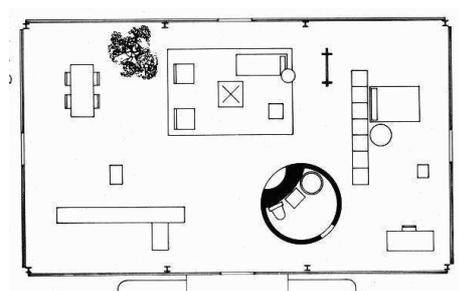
Casa de Vidro, New Canaan, Philip Johnson, 1949. Planta.
